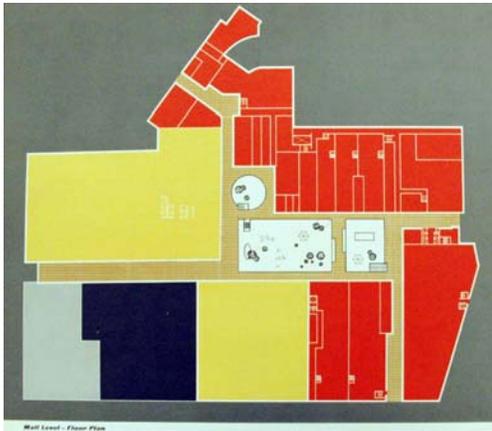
Rochester, Grundriss Erdgeschoss
